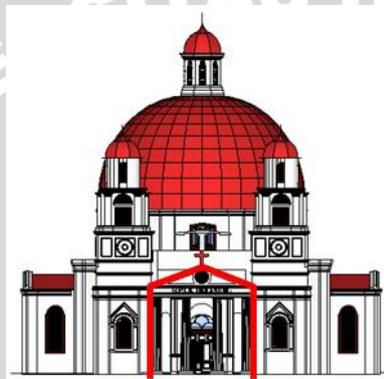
Kolom K2 pada fasade bangunan Gereja Blenduk
